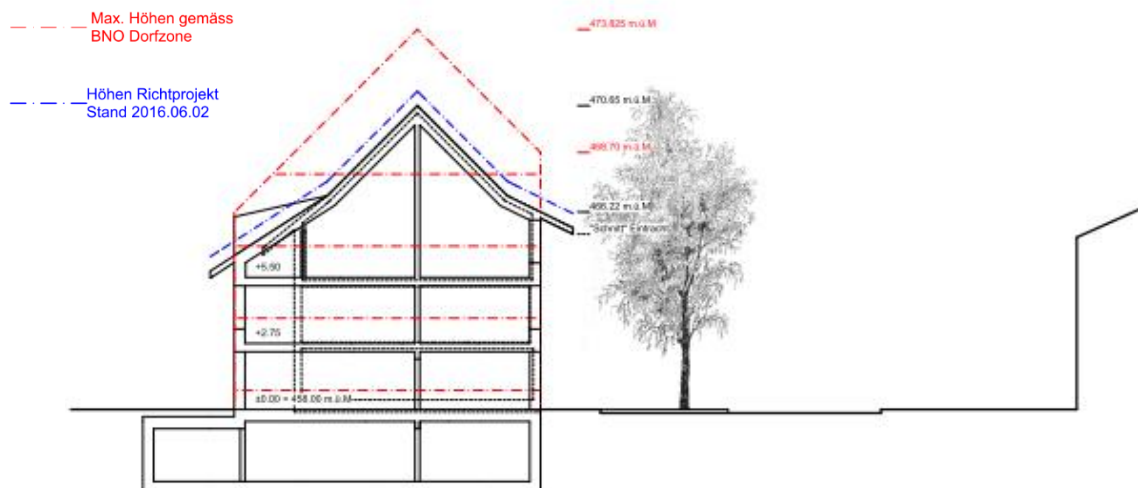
Schnitt Baubereich A mit Höhenbegrenzungen
